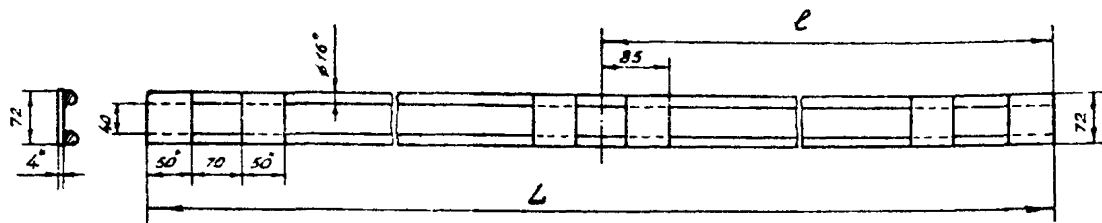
Мехрамная стяжка в виде сварного каркаса из стали круглого сечения
